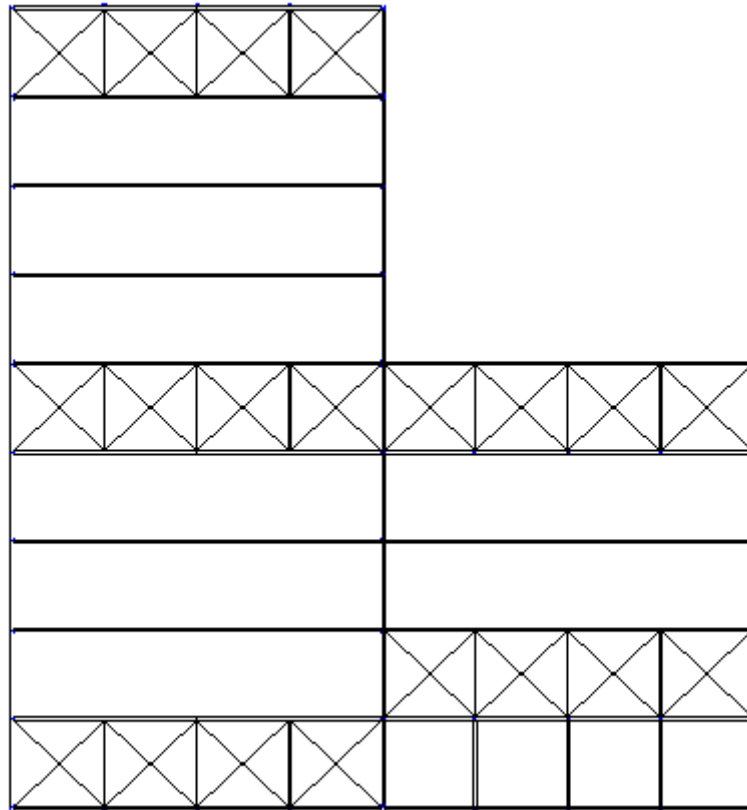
vista en planta de la situació de les creus de Sant Andreu.
